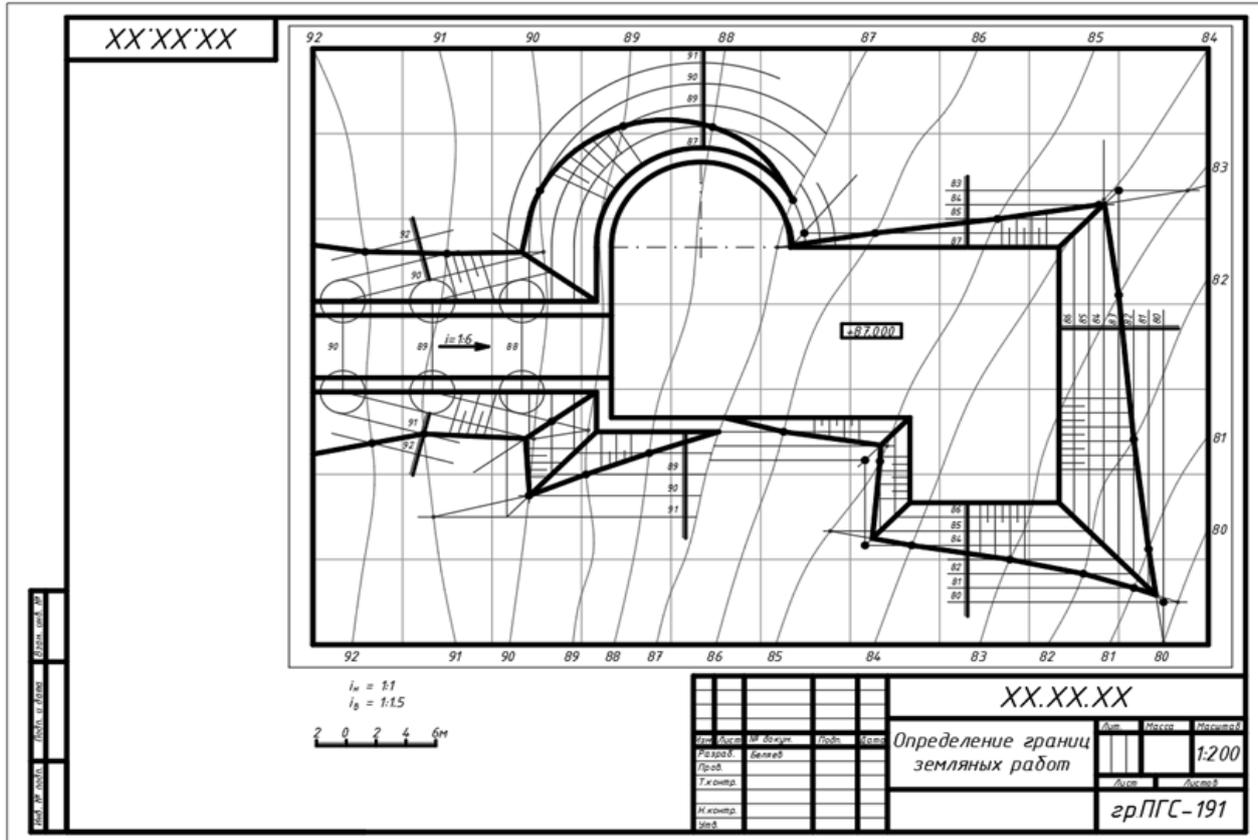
Индивидуальное задание № 5 «Определение границ земляных работ»
